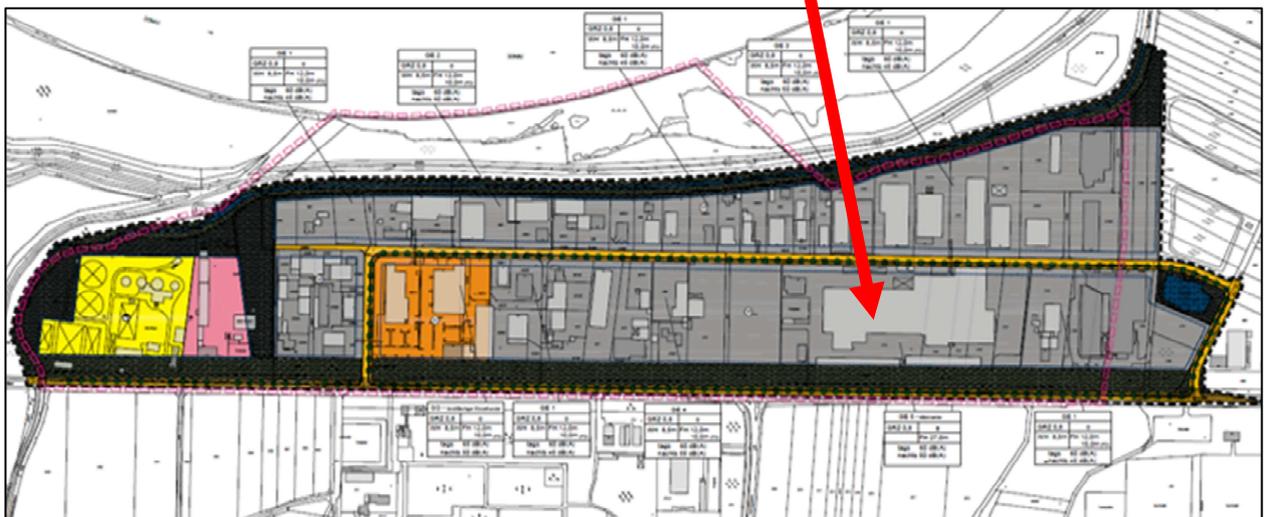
Planzeichnung zum Stand der 2. Änderung nach /21/
